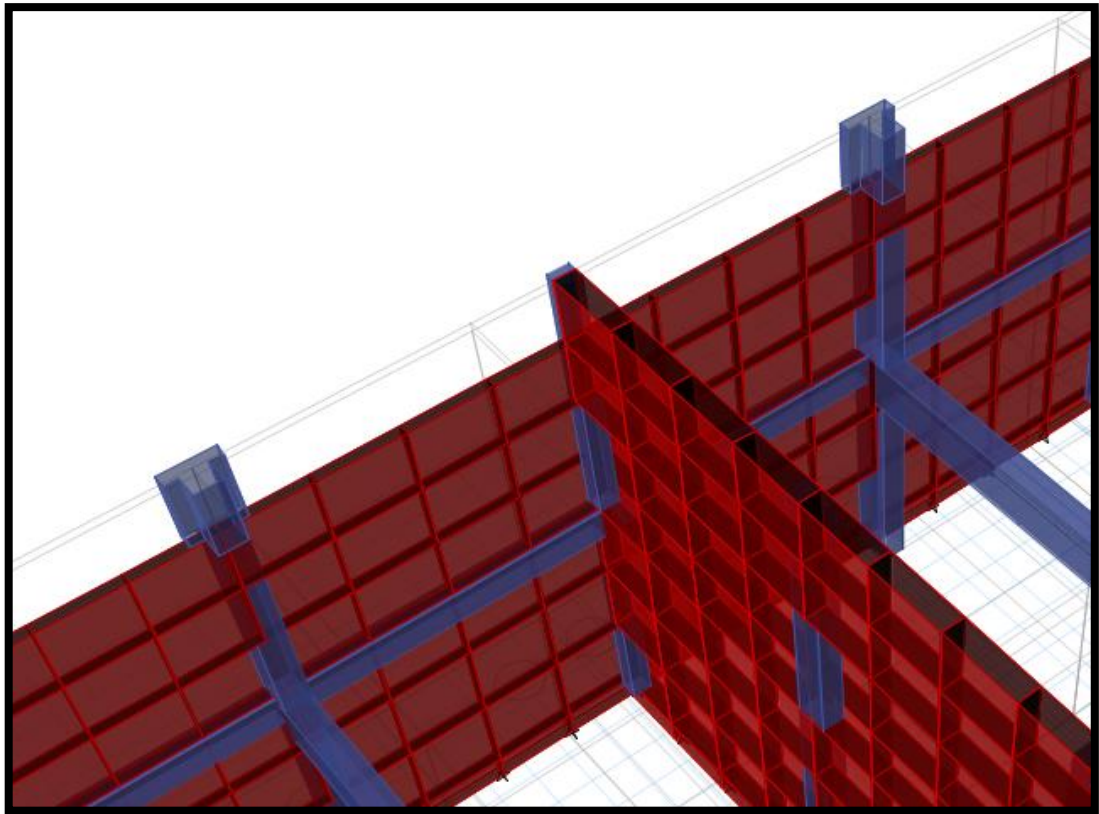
Vista en 3D del reforzamiento de las columnas en ETABS
